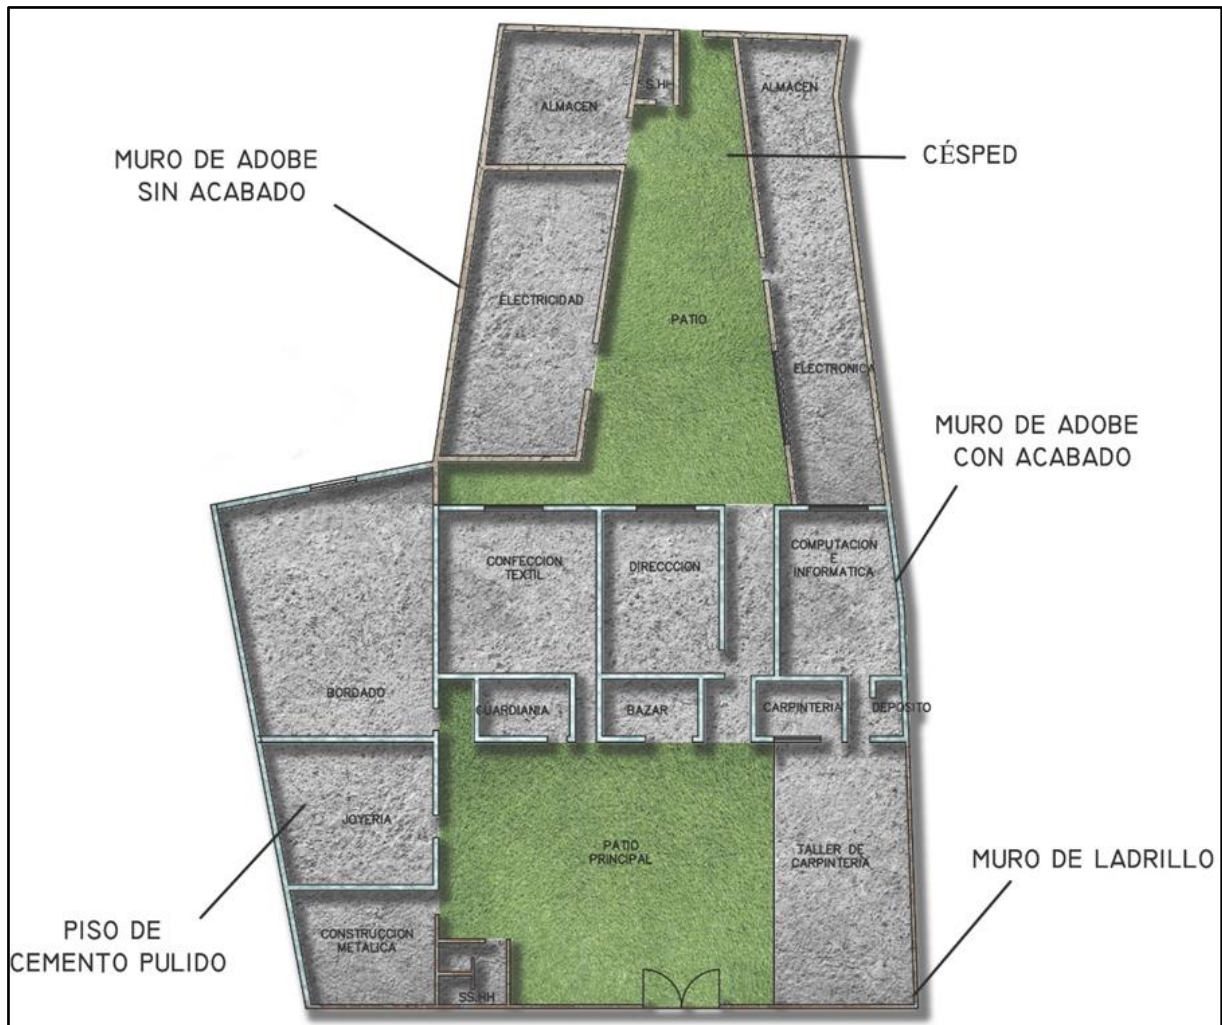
primera planta del CETPRO con detalles estructurales – Fuente: elaboración propia.
